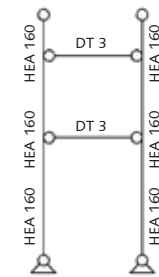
Grundriss Rahmen Ib [m]
